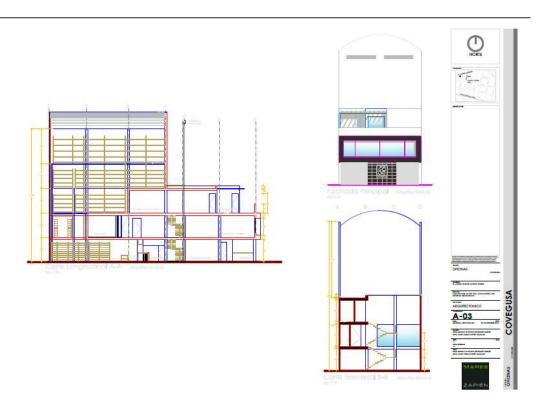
Plano de cortes y fachada, cortesía del autor.
